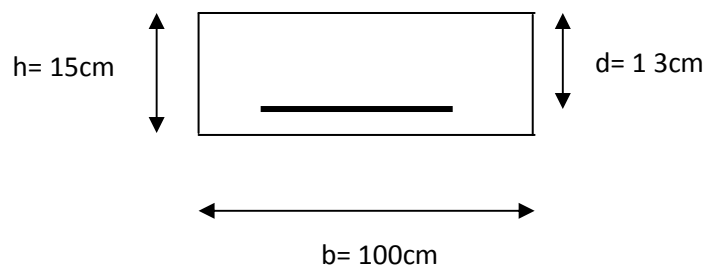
coupe verticale du plancher en dalle Pleine.
